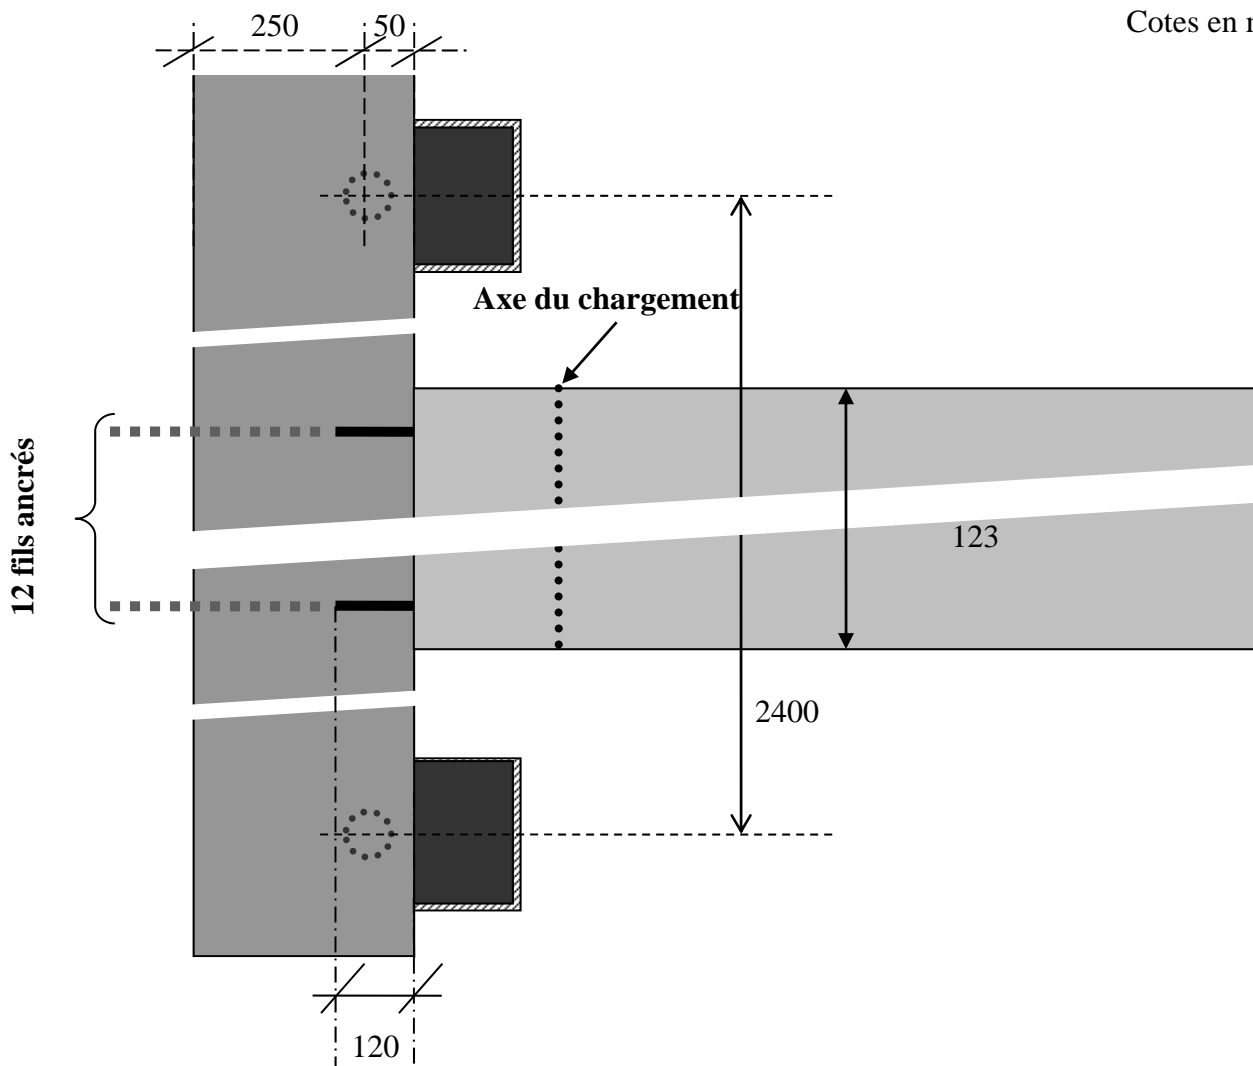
Vue en plan du montage des essais avec l'appui indirect N° 1 et N° 2
